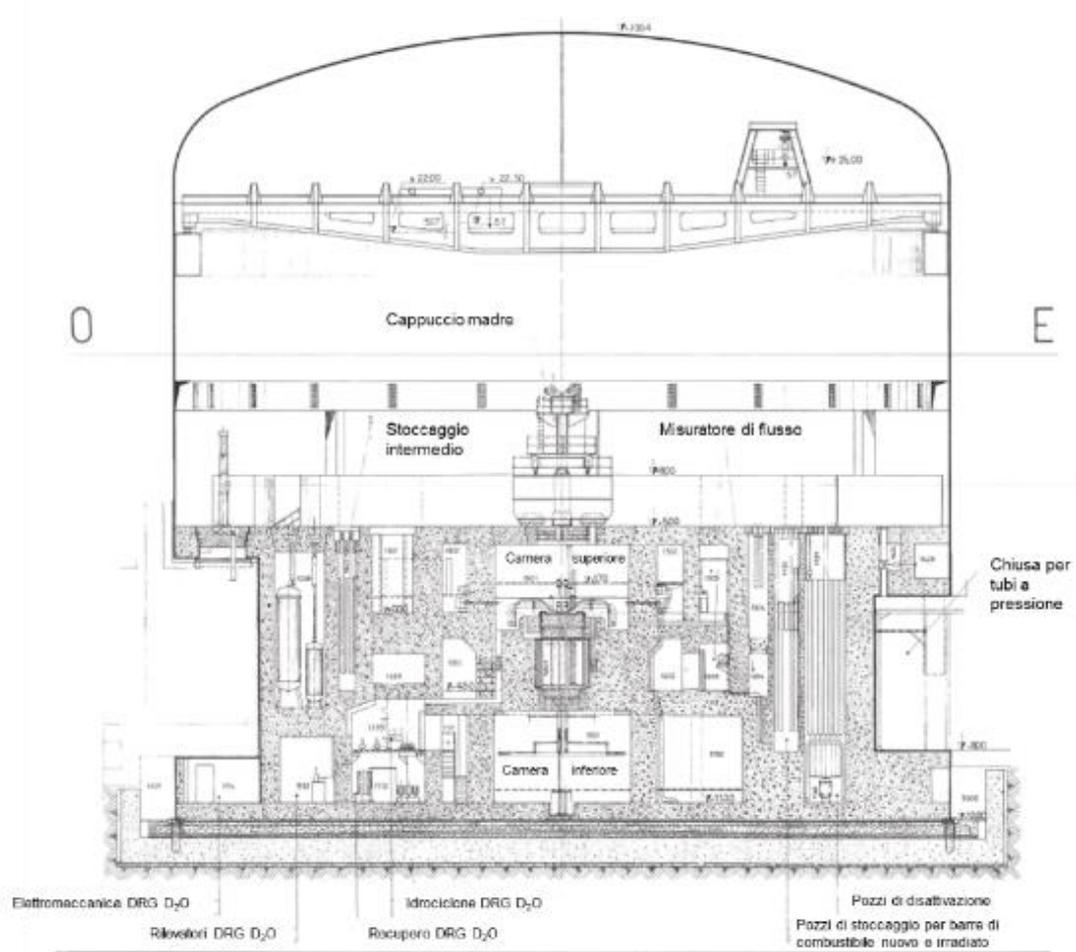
Edificio 80 – Sezione e prospetto trasversale O-E
